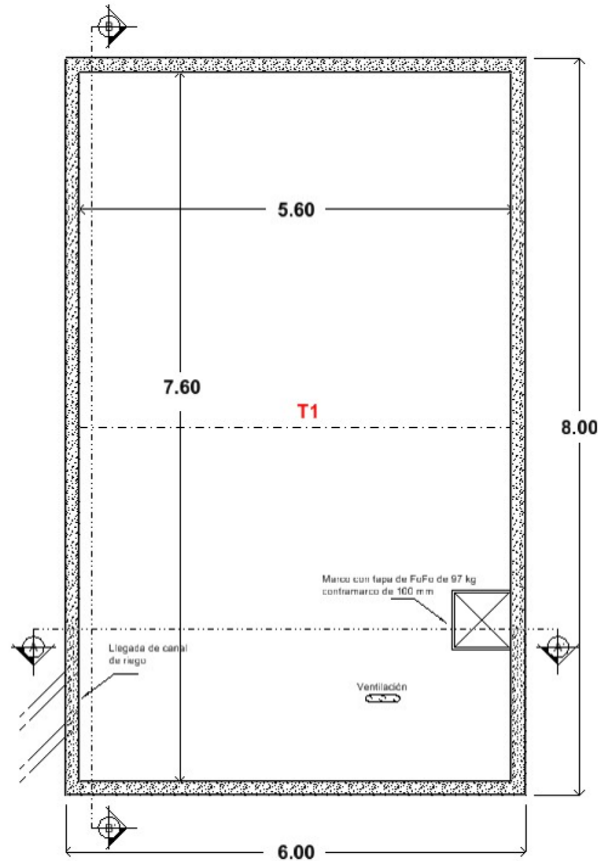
Dimensiones tanque de almacenamiento, Planta.
